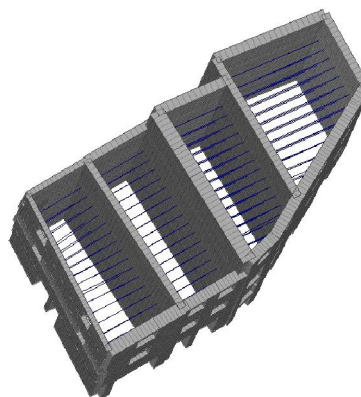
Distribuição dos barrote dos pavimentos em madeira.
